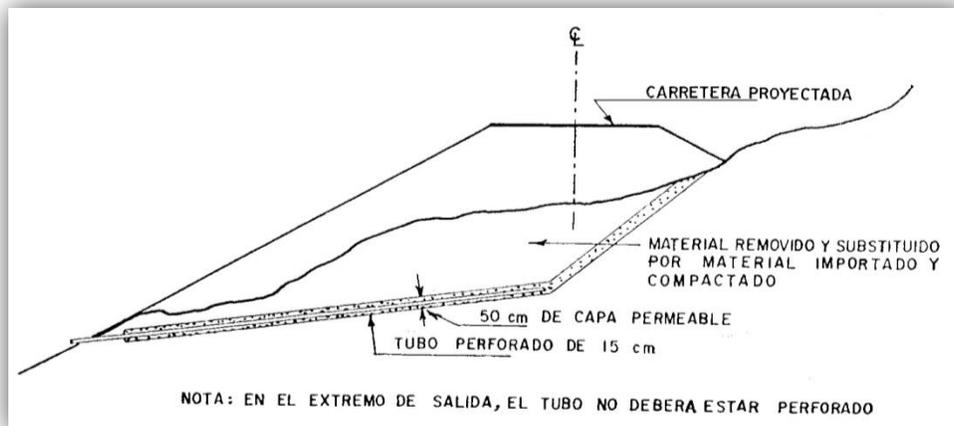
Remoción de material blando y colocación de una capa permeable bajo terraplenes.
